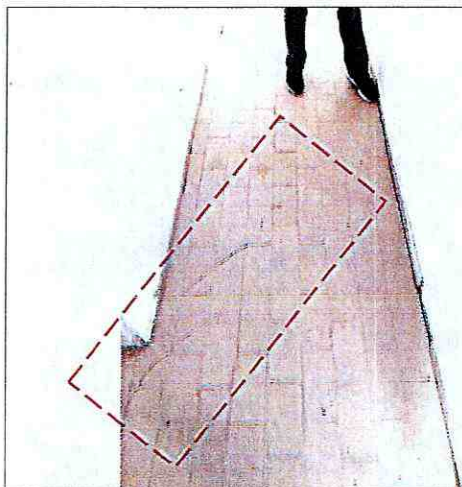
Fachada de P1B, sobre KR 1 Bis
